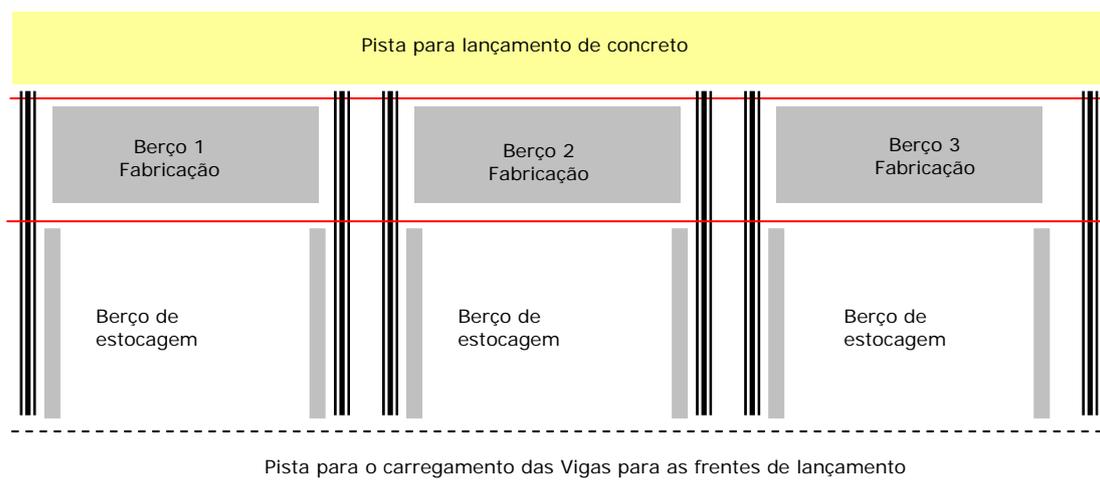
Layout* do pátio de fabricação das vigas pré-moldadas.
